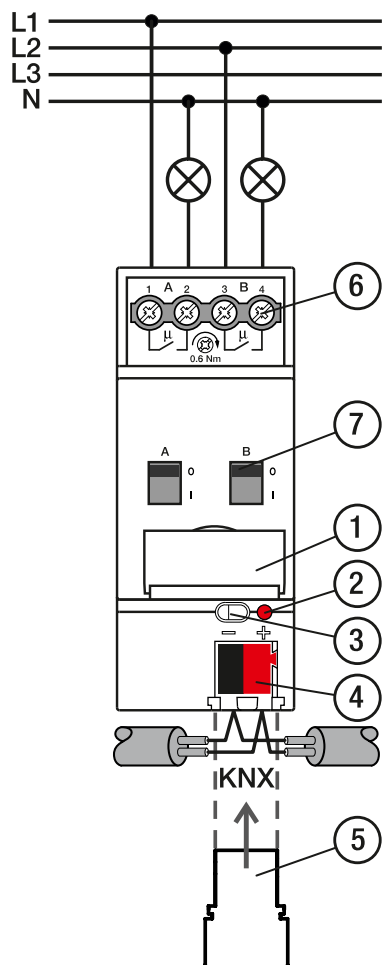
Schema di collegamento SA/S 2.x.x.2
